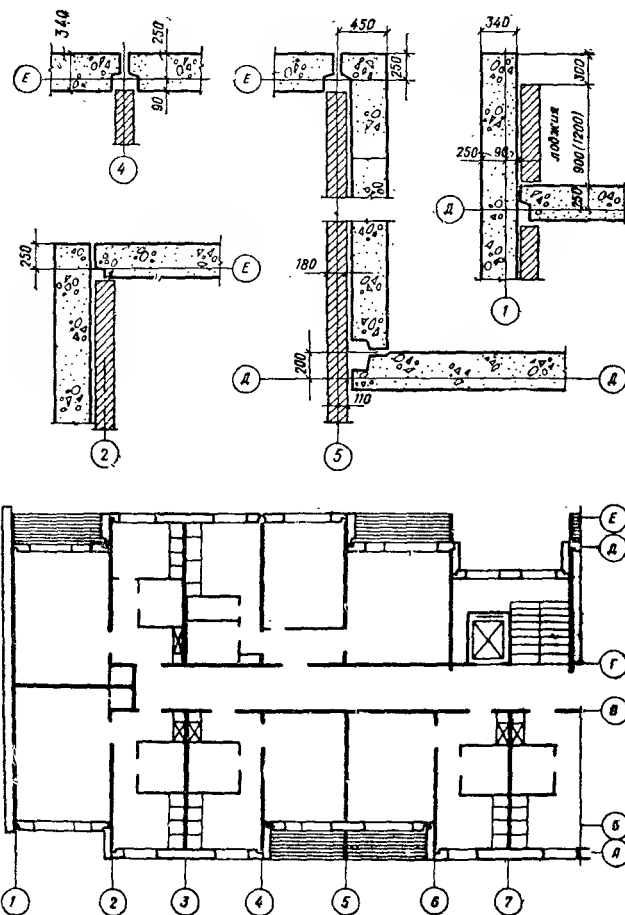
Схемы сопряжений панелей наружных и внутренних стен с привязками их к разбивочным осям
